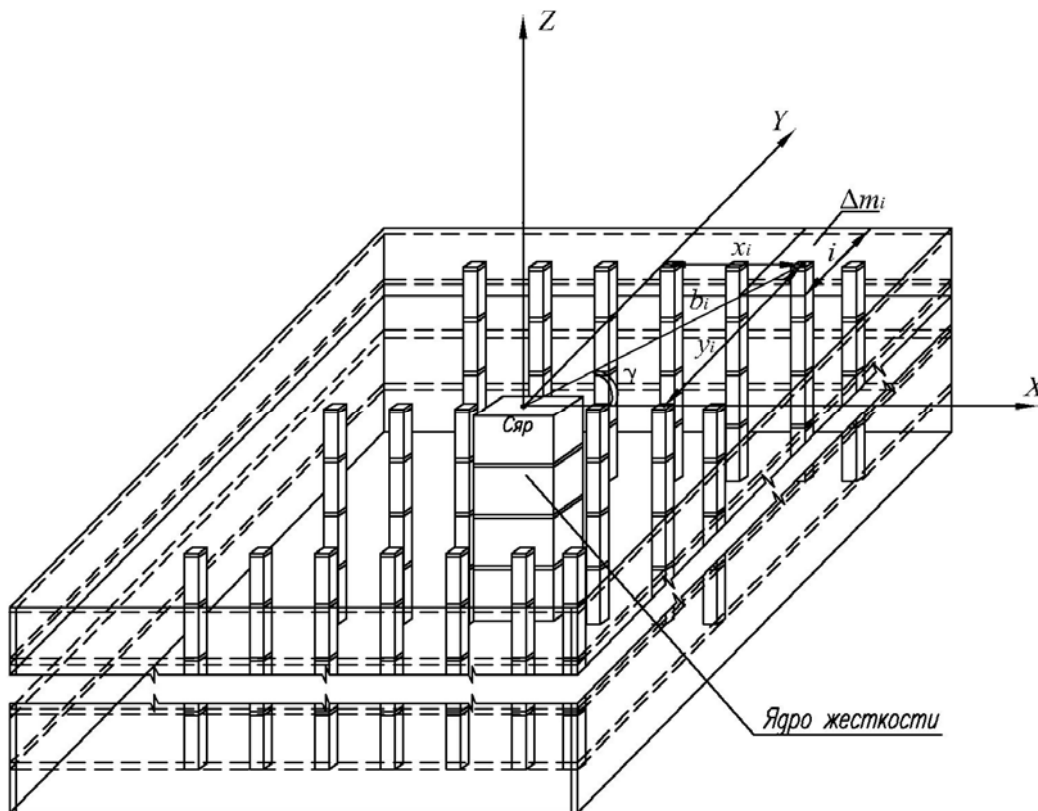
Схема высотного здания (перекрытия условно показаны прозрачными)
